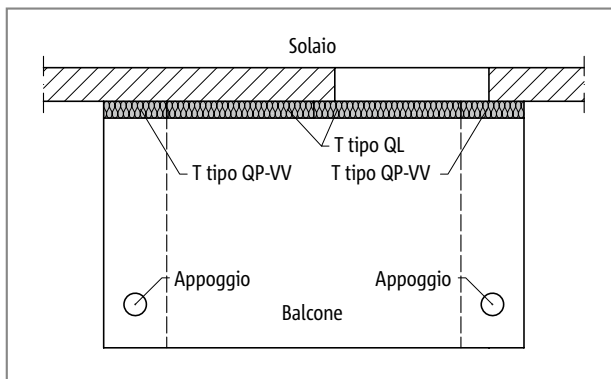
Schöck Isokorb® T tipo QP-VV e QL: balcone con appoggio su pilastri, collegamento con diversi gradi di rigidità dell'appoggio
